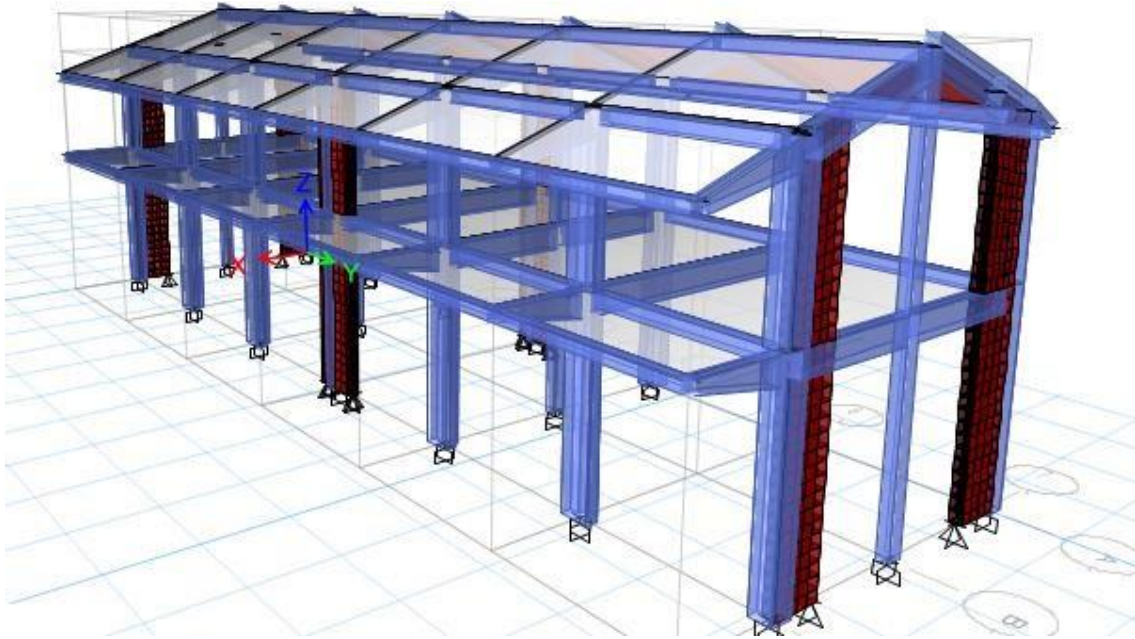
Modelo tridimensional Bloque I, desarrollado en ETABS.
